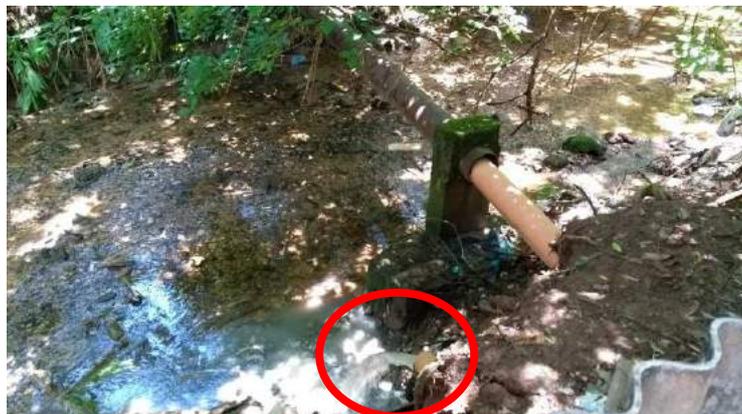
Entrada de galeria pluvial em mau estado de conservação
